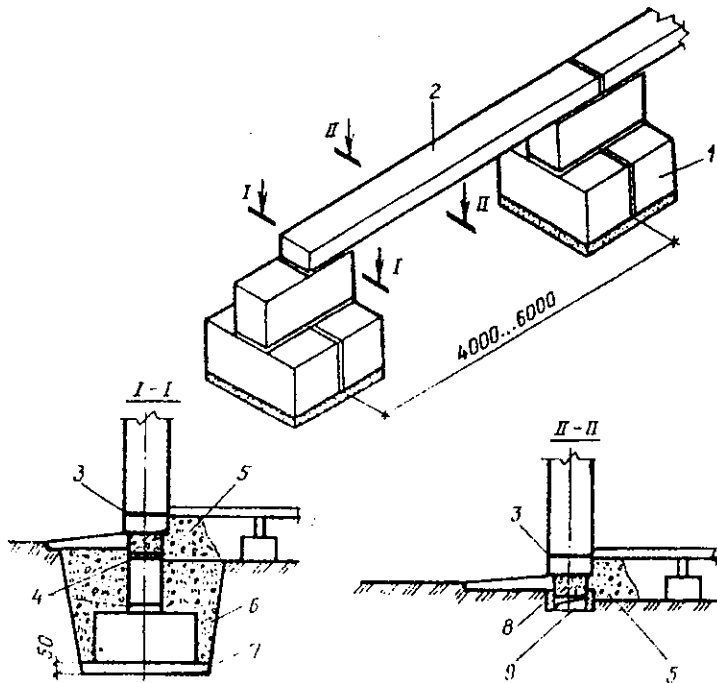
Столбчатые фундаменты из сборных железобетонных элементов 1 — сборные бетонные блоки шириной 300, 400 или 500 мм; 2 — сборная железобетонная фундаментная балка; 3 — гидроизоляция из двух слоев рубероида на битумной мастике; 4 — гидроизоляция из слоя цементного раствора состава 1 : 2; 5 — отсыпка керамзитовым гравием; 6 — обратная засыпка грунтом; 7 — выравнивающая песчаная подушка; 8 — просмоленная доска; 9 — зазор 50 мм между балкой и грунтом
